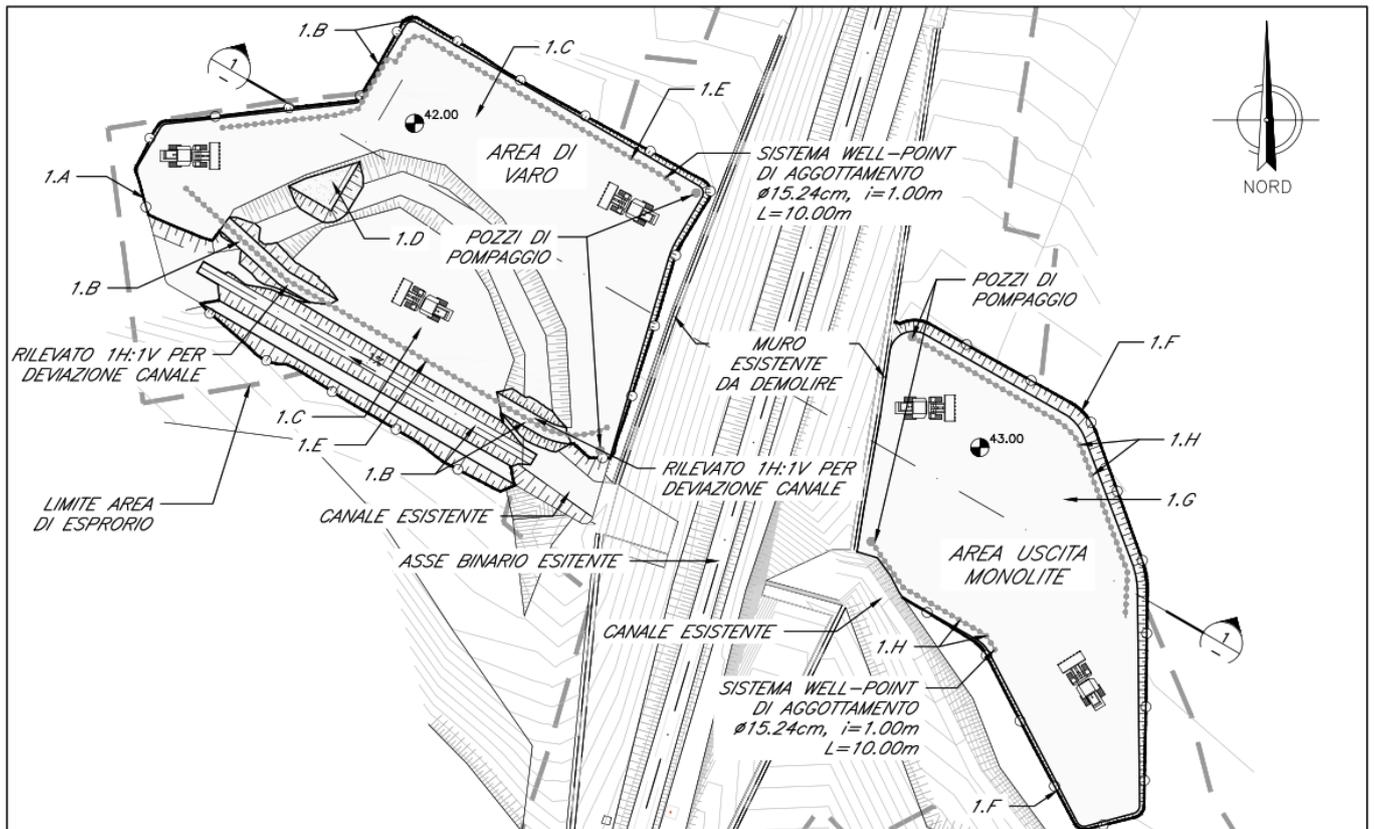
Inquadramento planimetrico delle trincee di varo e di arrivo
